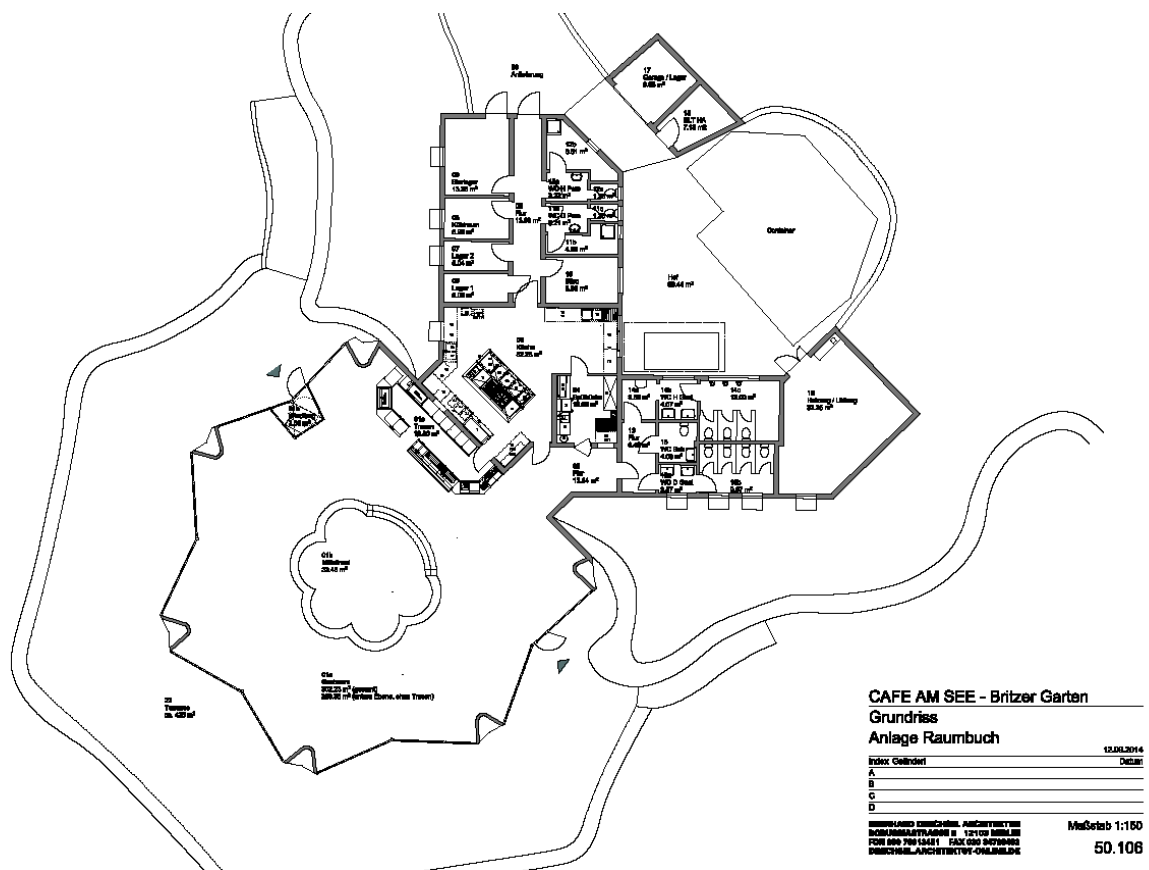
Grundriss Britzer Seeterrassen (Bernhard Drechsel Architekten)
